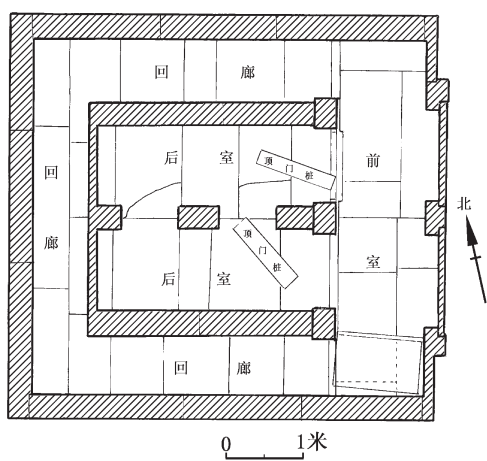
河南省唐河钺織庵汉墓平面图 (1/100)
